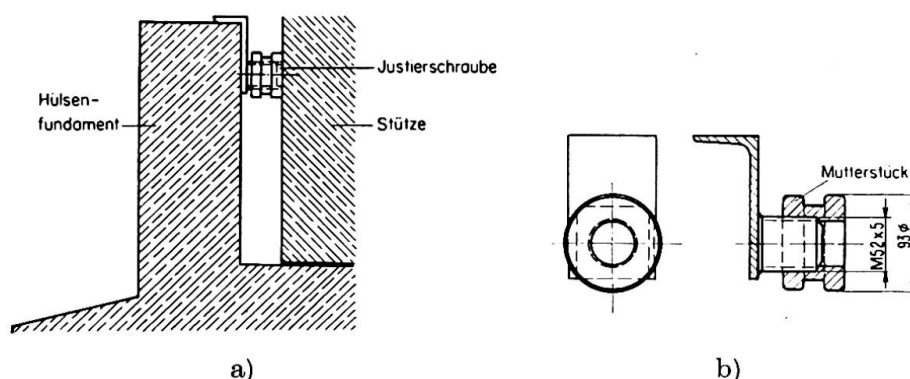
a) Justieren schwerer Stützen mittels Justierschrauben [3].
